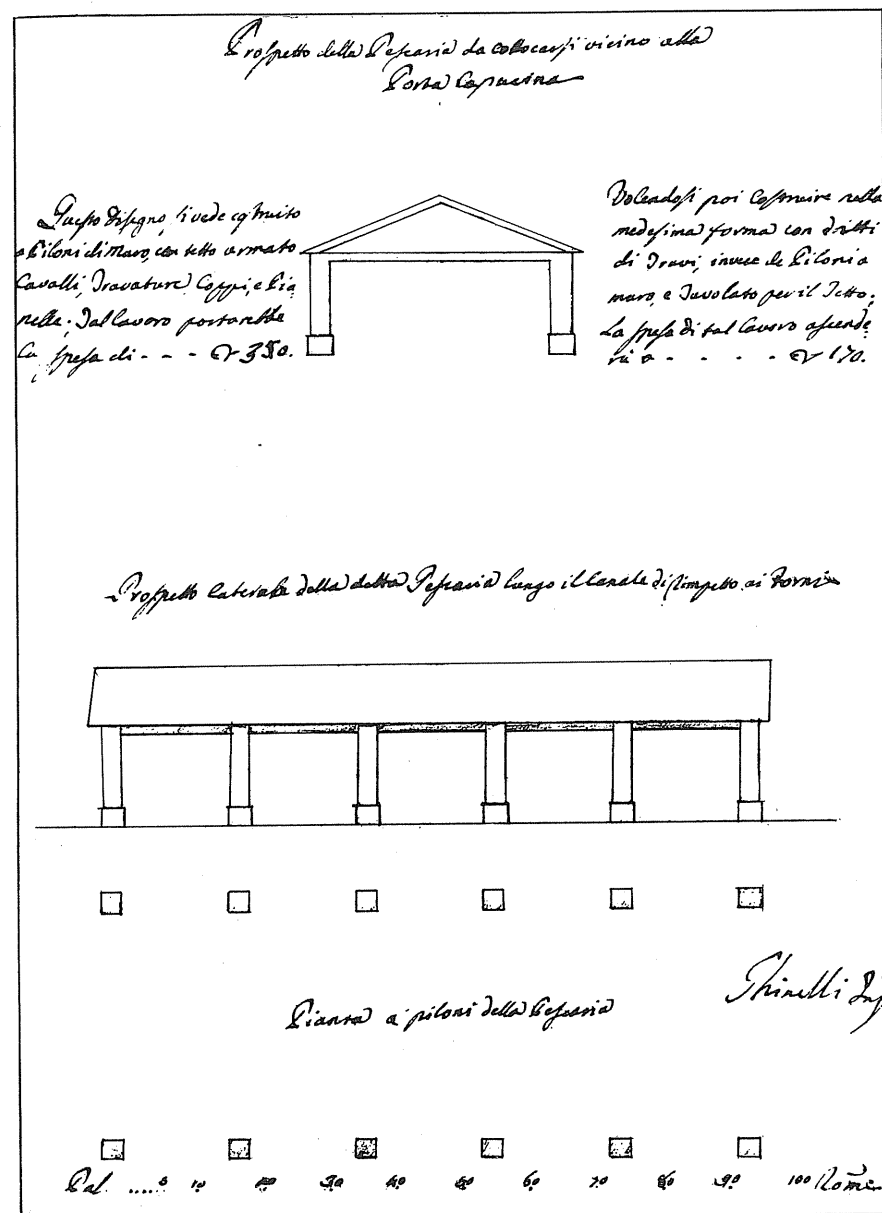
Senigallia (AN): Pescheria «da collocarsi presso Porta Cappuccina» (1815), arch. Pietro Ghinelli, pianta e prospetti.
